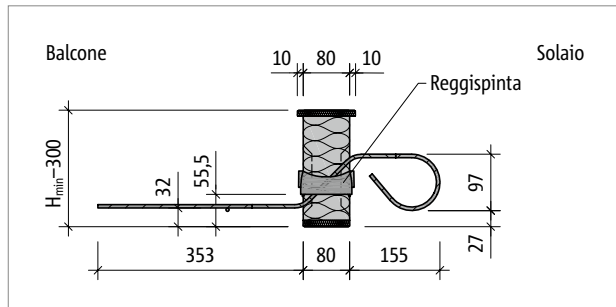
Schöck Isokorb® T tipo QL-V1: sezione del prodotto
